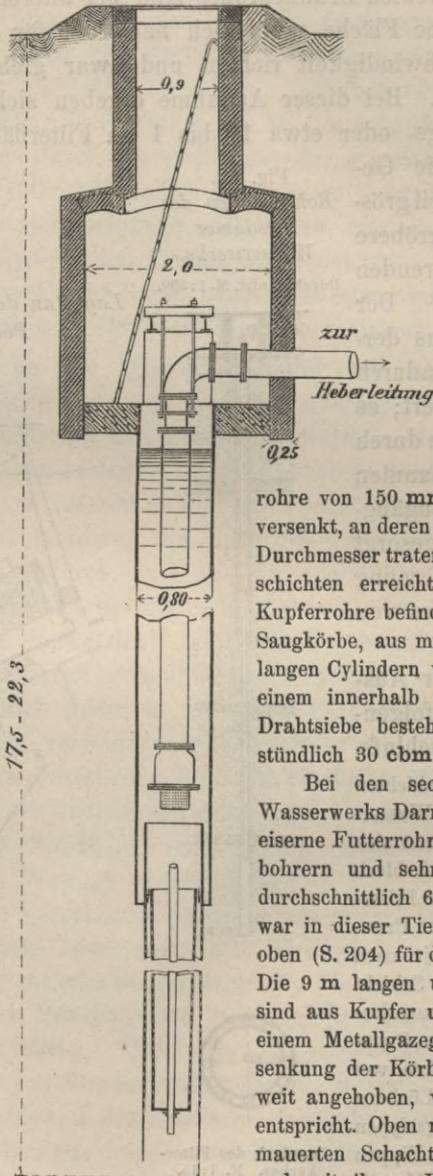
giebt den Längenschnitt einer Brunnenanlage, welche für die Hildebrand'sche Brauerei in Pfungstadt ausgeführt ist. Es handelte sich im vorliegenden Falle darum, das Wasser in den 26,5 m tief liegenden Kies-schichten zu erreichen, über welchen schwer zu durchsetzende Schichten von Trieb-sand und unreinem Materiale lagern. Zu diesem Behuf wurden zwei eiserne Futterrohre von 150 mm Durchmesser durch Bohrung versenkt, an deren Stelle Kupferrohre von 100 mm Durchmesser traten, nachdem die erwähnten Kies-schichten erreicht waren. An den Enden der Kupferrohre befinden sich sorgfältig hergestellte Saugkörbe, aus mit Schlitz versehenen 1,50 m langen Cylindern von 120 mm Durchmesser und einem innerhalb derselben befindlichen, feinen Drahtsiebe bestehend. Dieser Brunnen liefert stündlich 30 cbm (8,3 sl).
